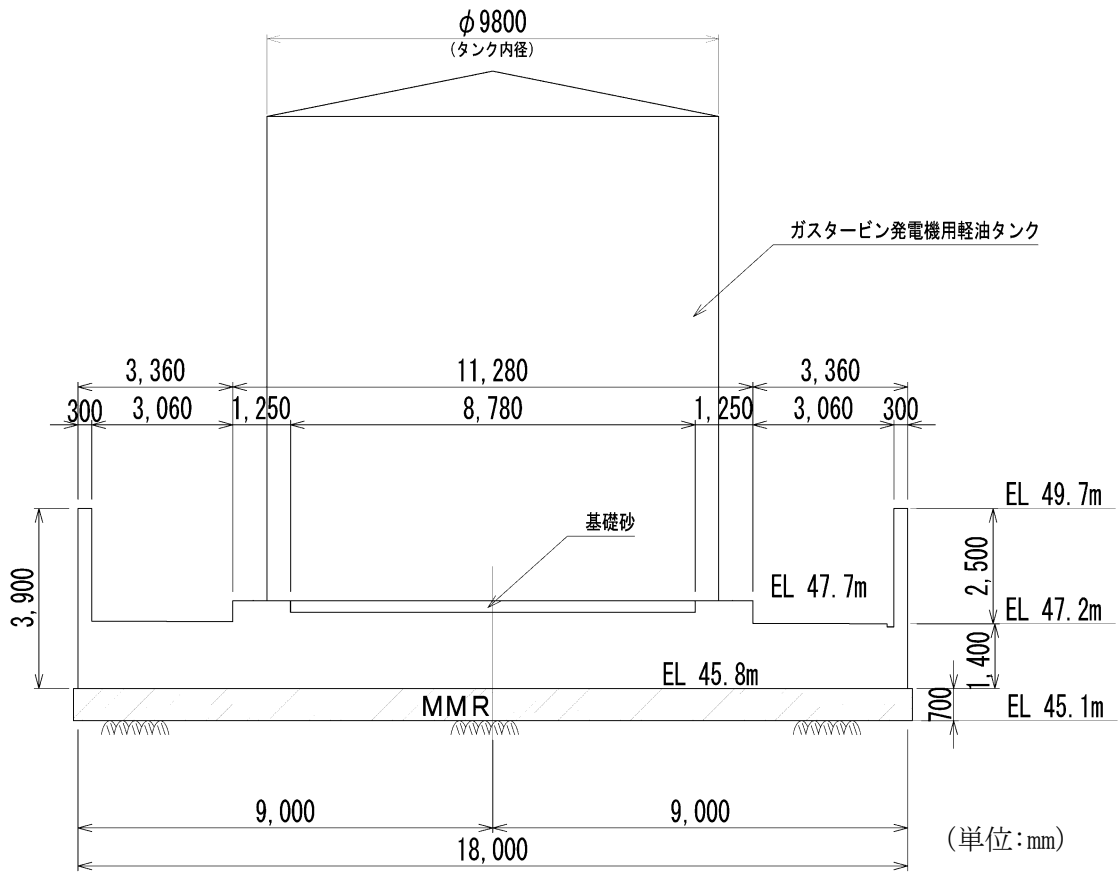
ガスタービン発電機用軽油タンク基礎 断面図
